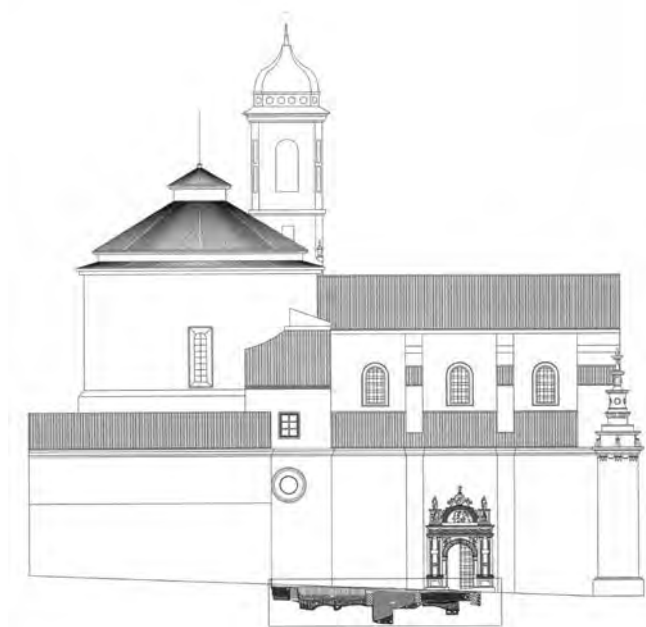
Proyección de la estratigrafía en el alzado norte de El Salvador.
